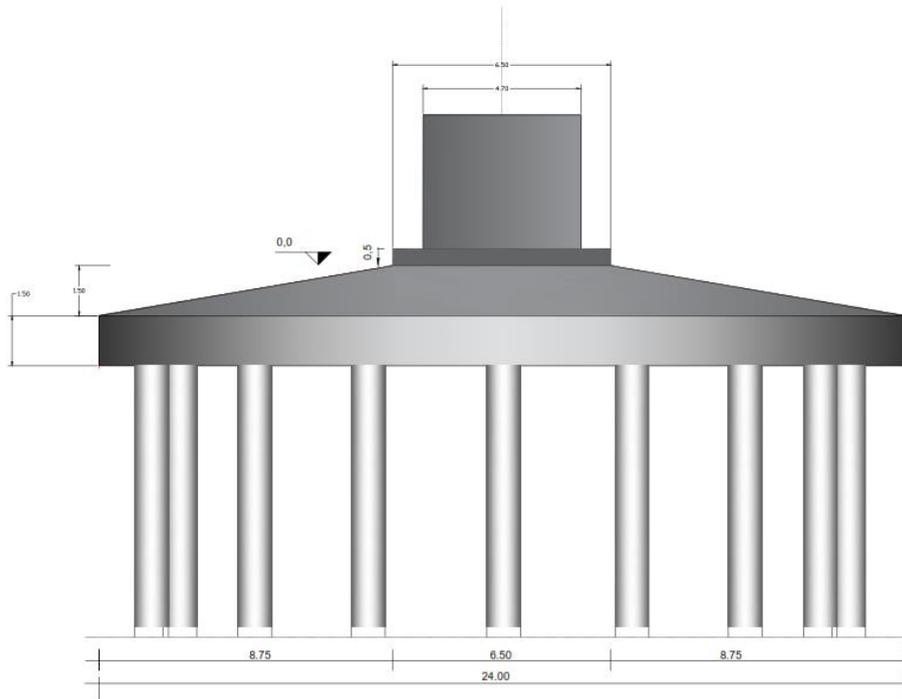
Schema geometrico di riferimento della struttura di fondazione
